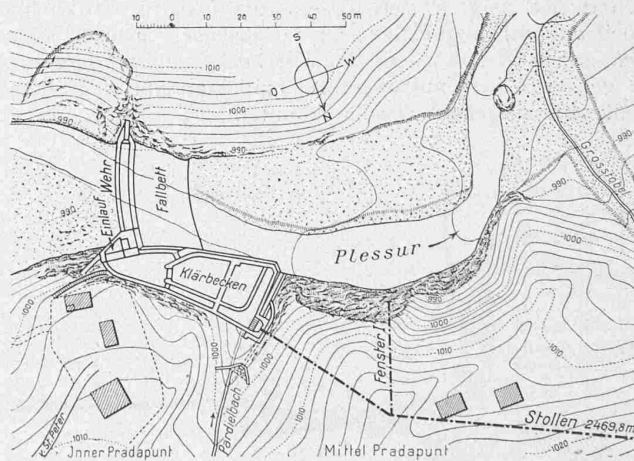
Lageplan von Wehr und Wasserfassung. — 1:2000.
